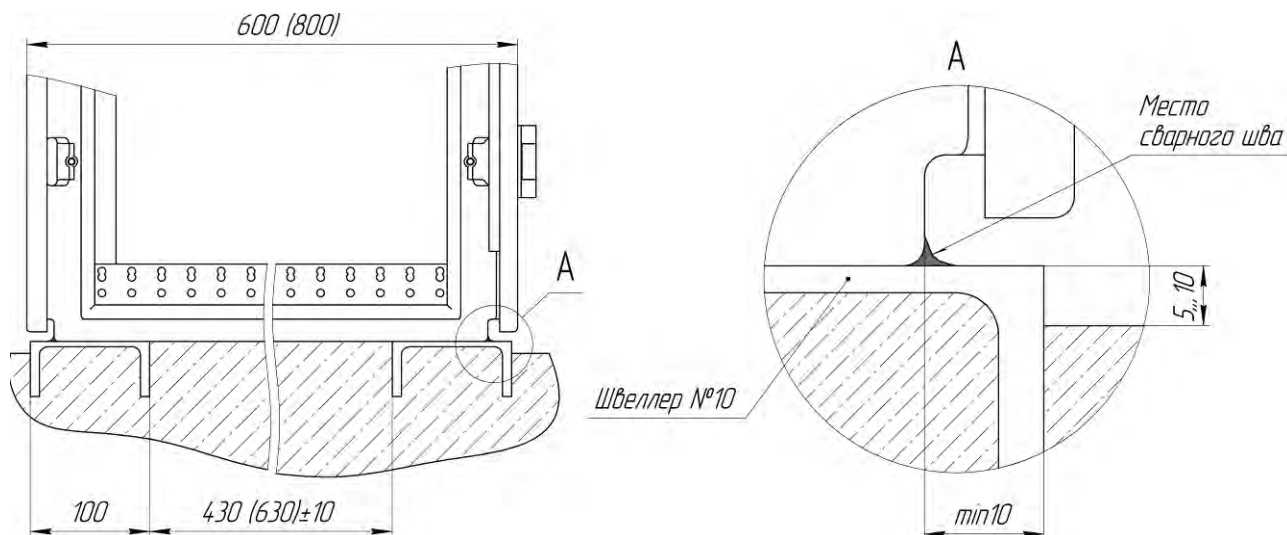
Крепление ШРОТ к закладным элементам при помощи сварки
